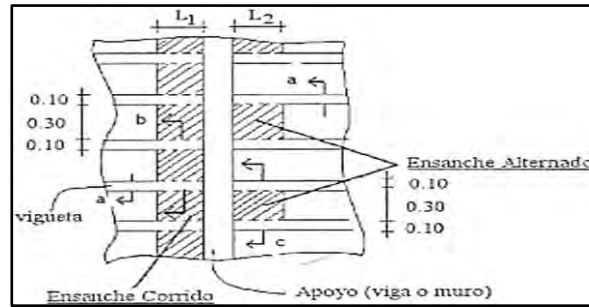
Ensanche alternado y corrido en losas aligeradas (Ottazzi, 2016).
